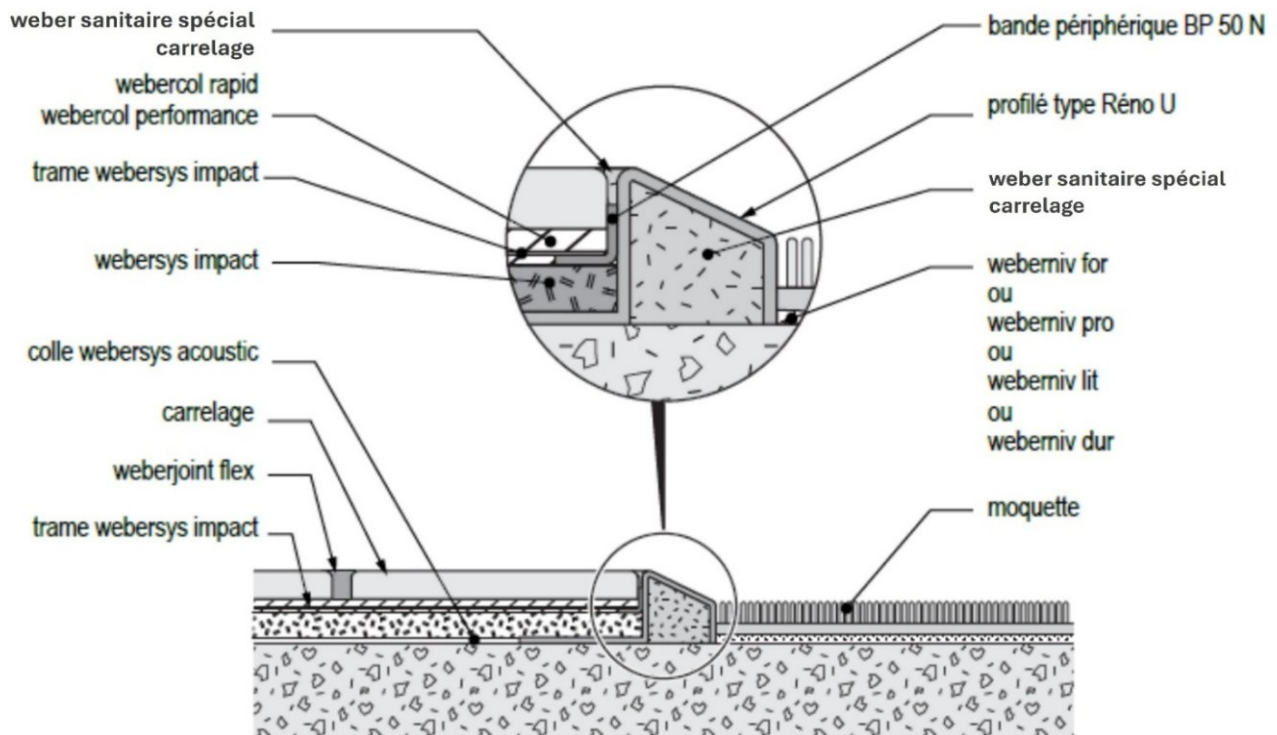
Traitement d'un seuil de porte – cas d'un revêtement textile dans le local adjacent
